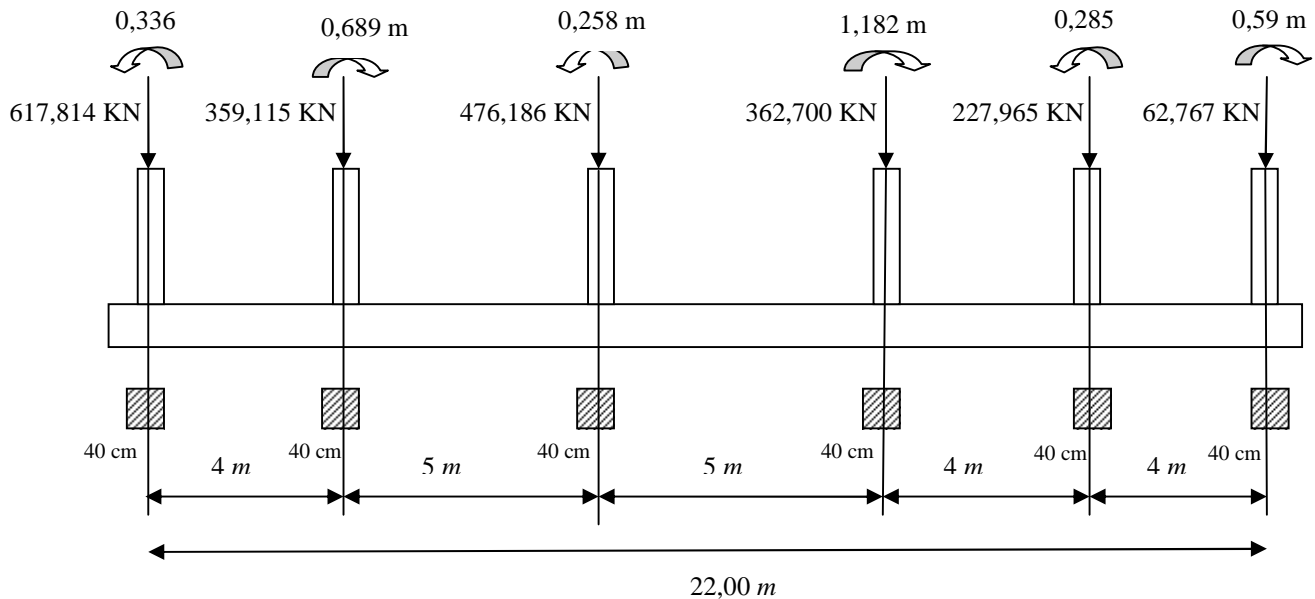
La surface des semelles filantes sous poteaux (file des poteaux les plus sollicitées)
